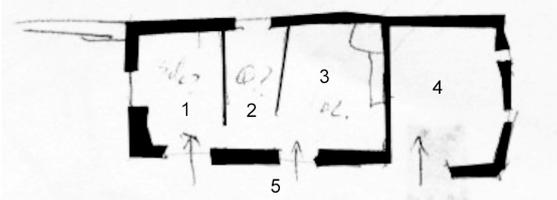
Planta esquiçada da Casa Elementar Básica LN9
